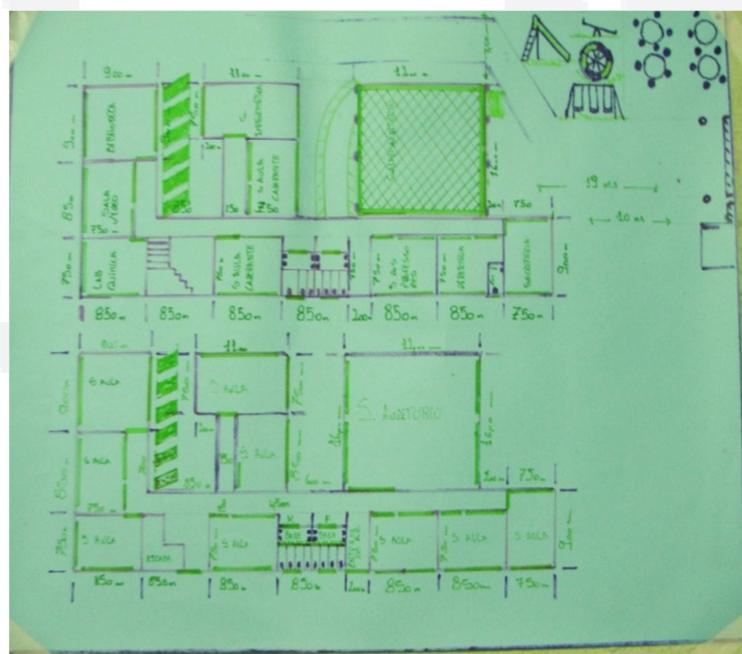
Foto da planta baixa desenvolvida pelo grupo G5
